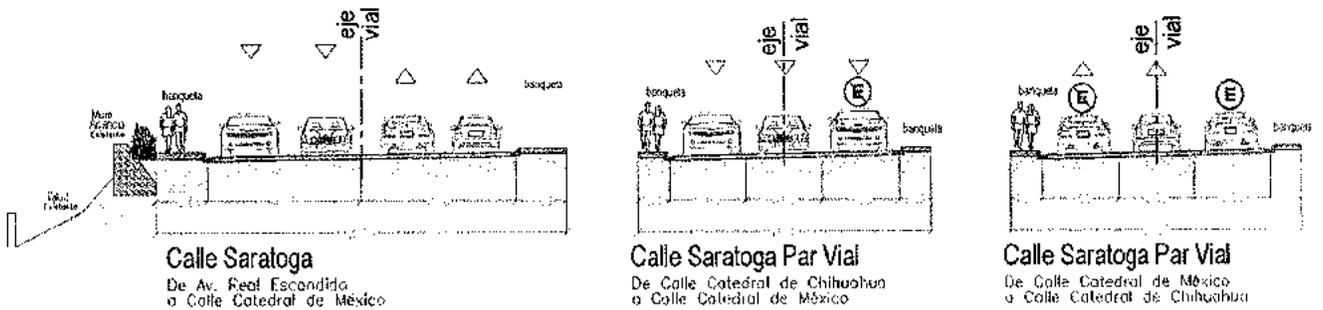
Propuesta de configuración geométrica a la sección vial.
